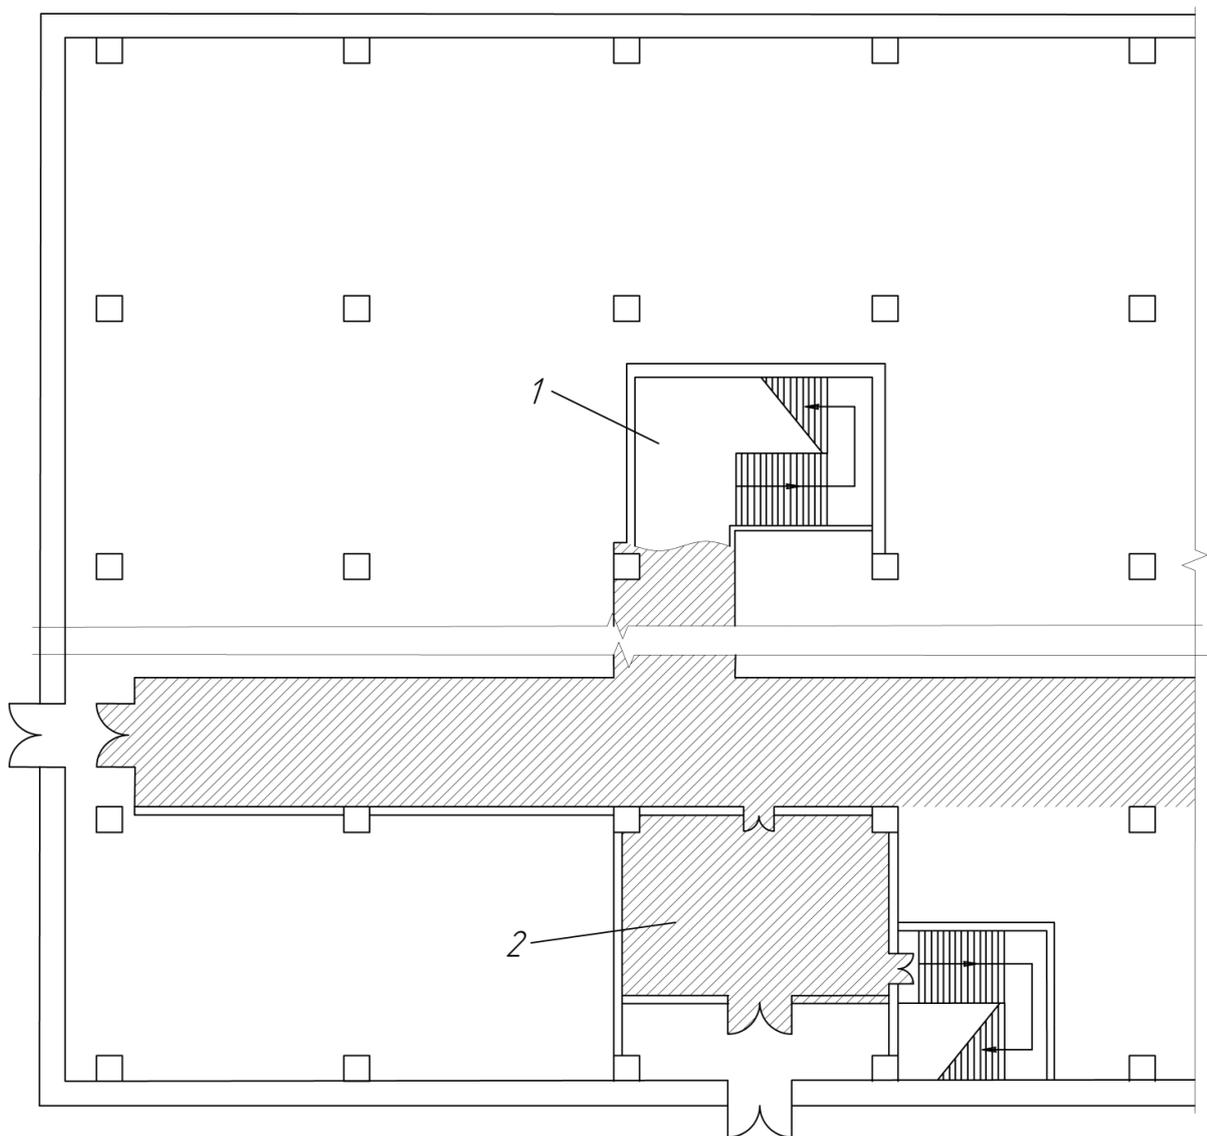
Лестницы в многоэтажном здании: 1 – лестничная клетка в средней ячейке каркаса; 2 – лестничная клетка у наружной стены
